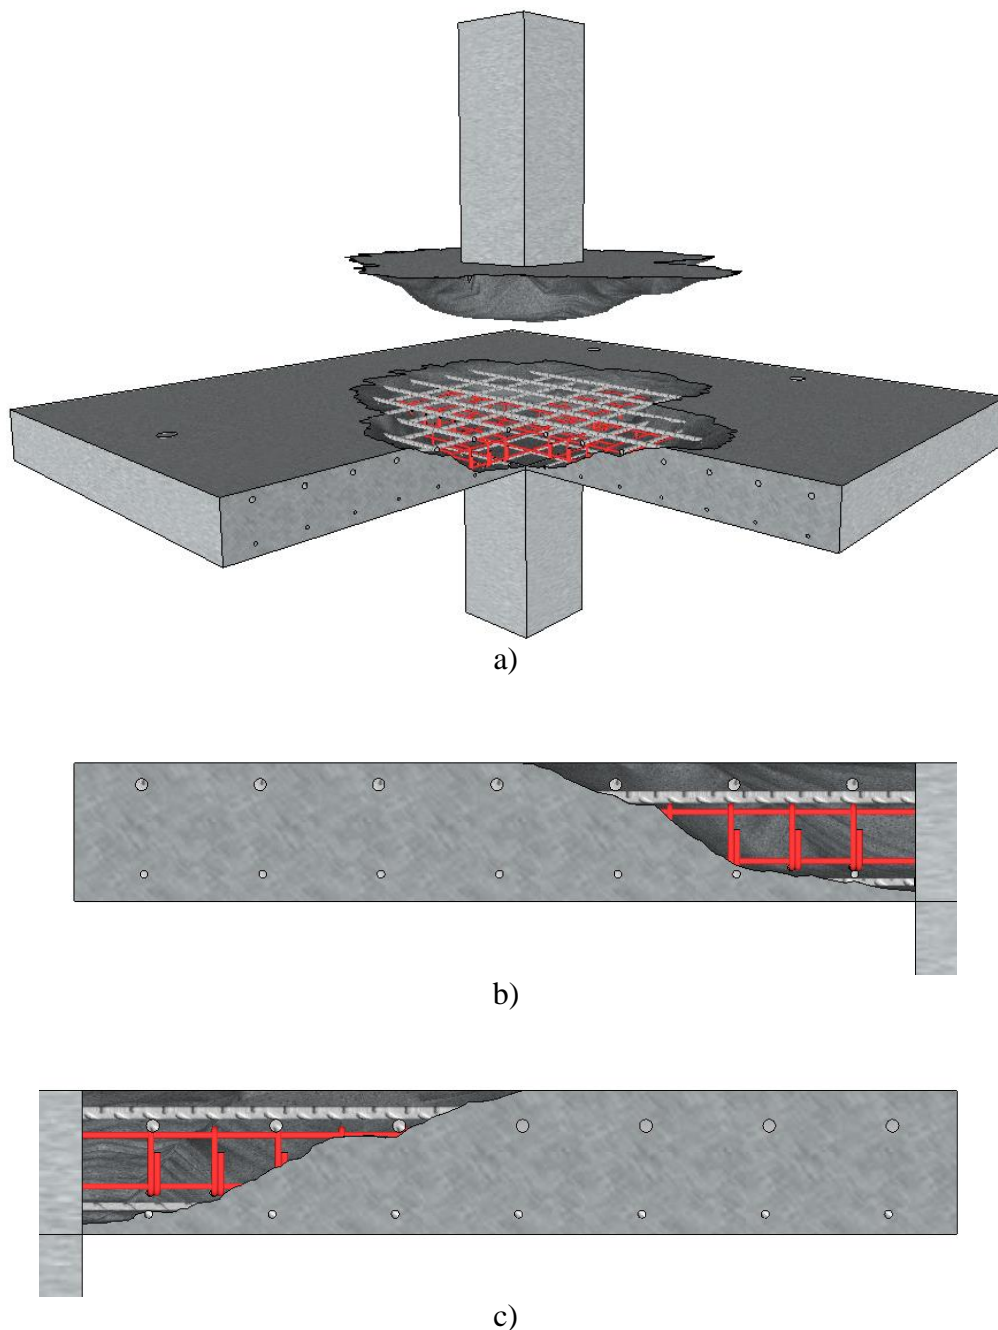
Superfície de ruptura e cone de punção da laje FS-3; b) Corte e superfície de ruptura do lado leste; c) Corte e superfície de ruptura do lado norte.
